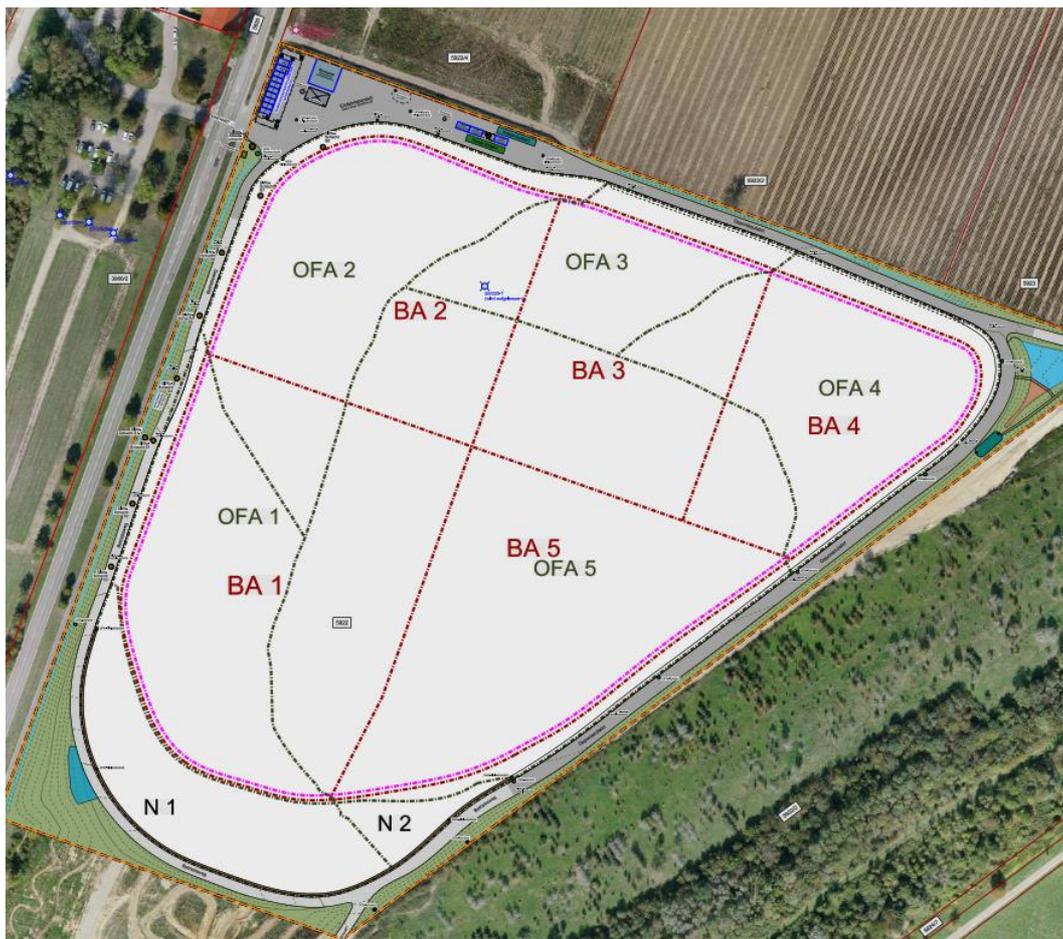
Übersichtslageplan der Bauabschnitte (Basis- und Oberflächenabdichtung).
